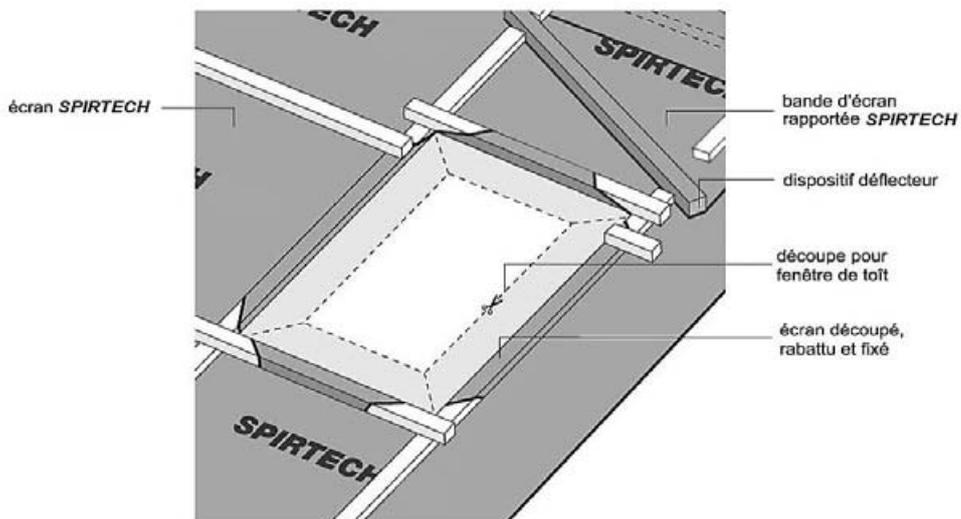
Pose sans ventilation de la sous-face – Fenêtre de toit
